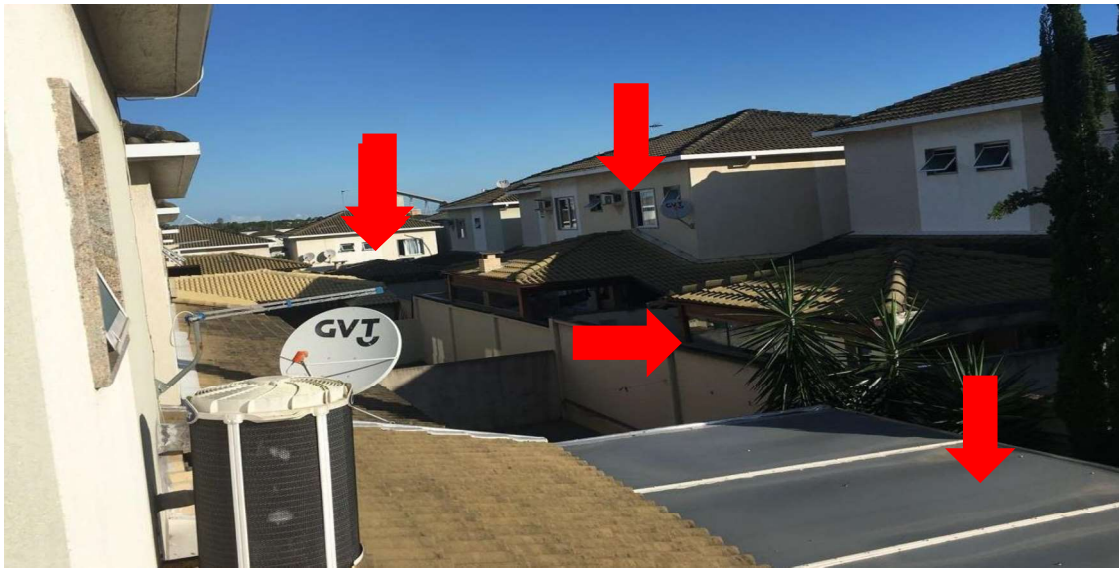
Acréscimos de área construída nos fundos dos terrenos, destacado nas
